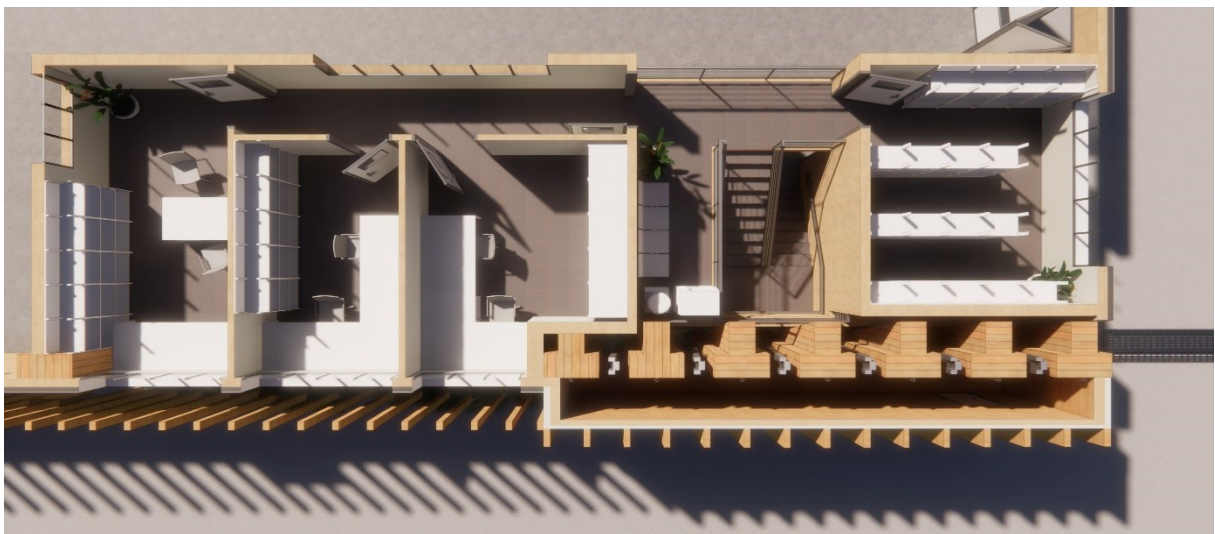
Pianta prospettica del piano primo del blocco uffici (moduli chiusi).
